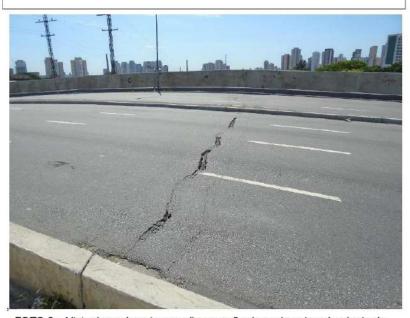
Vista do pavimento com disgregação do pavimento sobre junta de dilatação.
